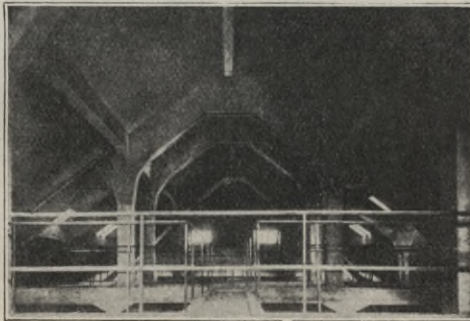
Dachraum im Rieselgebäude. Wasserwerk Pankow.
